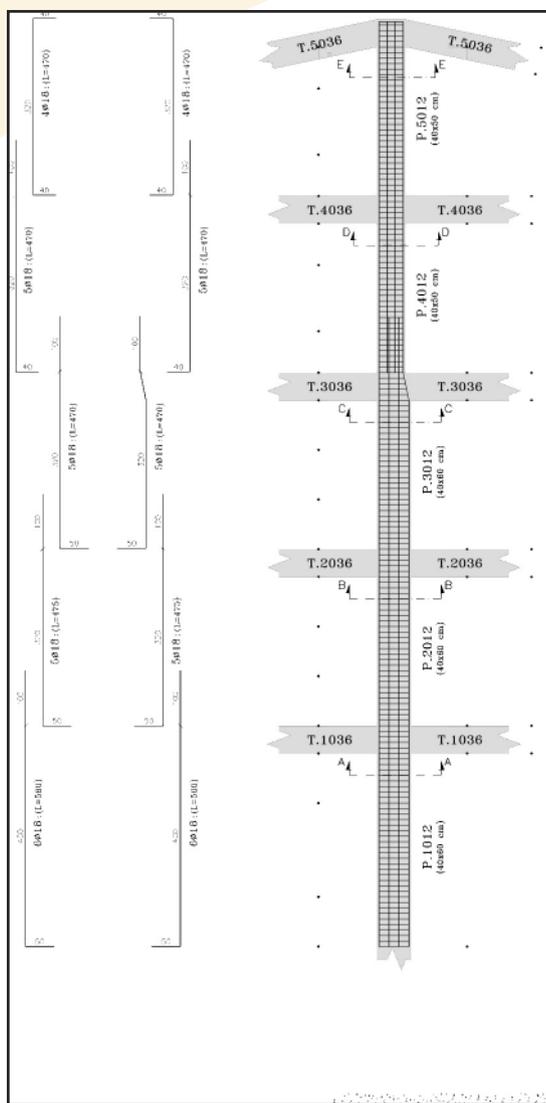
Distinta di armatura della pilastrata 1012-5015, edificio a base fissa (Vista YZ)
